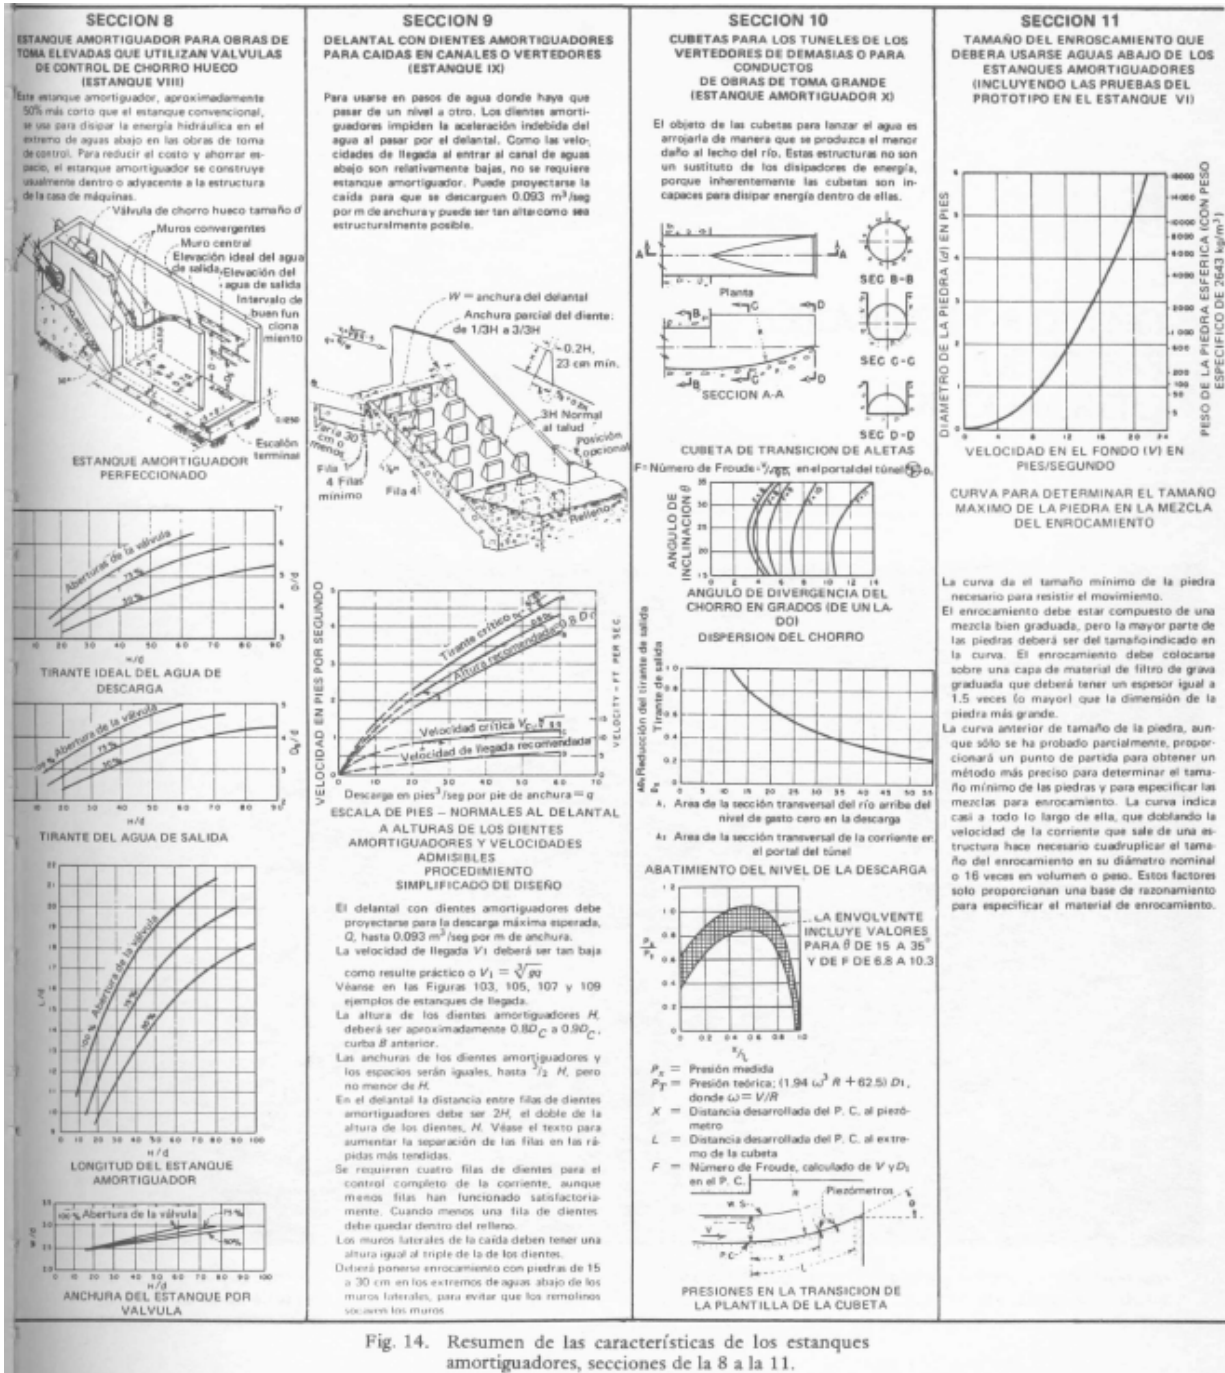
Resumen de las características de los estanques amortiguadores, secciones de la 8 a la 11.
